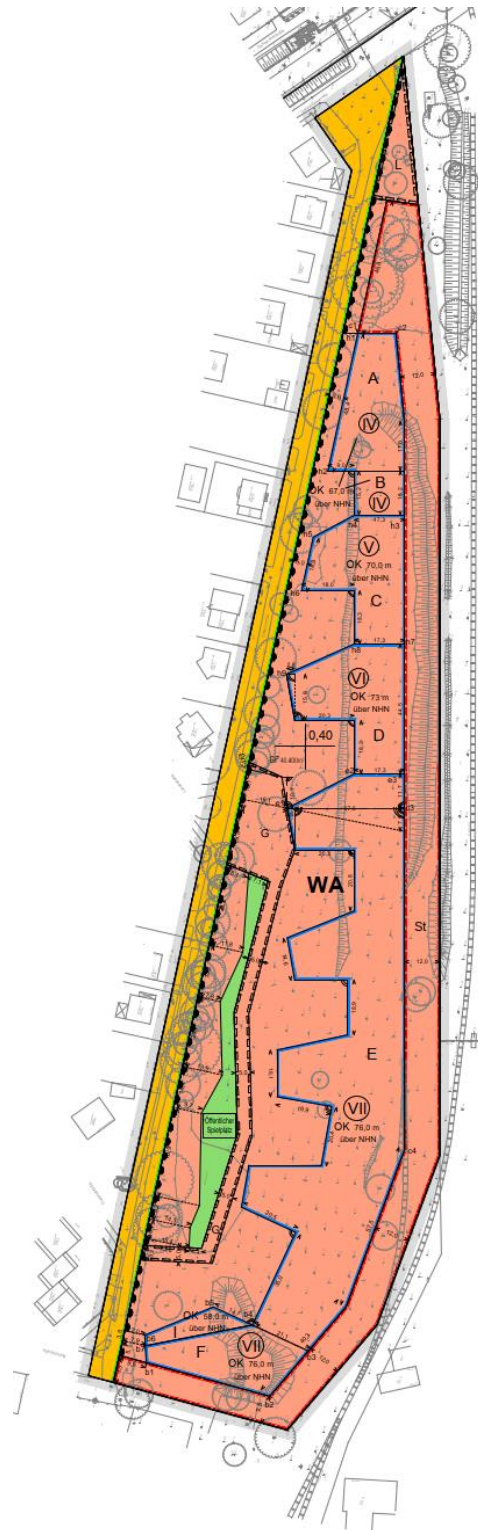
Bebauungsplan 11-157 an der Detlevstraße in Berlin mit geplanten Baubereichen (blaue Umrandung) und Einteilung der Flächen in allgemeines Wohngebiet (rote Färbung, WA) und Straßenverkehrsflächen (orange Färbung)
